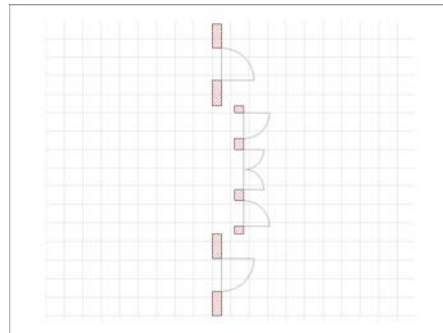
Wandbauteil im Grundriss
